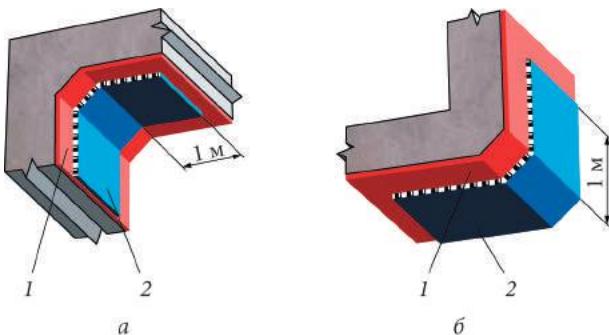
Устройство пристенного дренажа: *а* — внутренний угол; *б* — внешний угол; 1 — гидроизоляционное покрытие; 2 — профилированная мембрана *PLANTER geo
